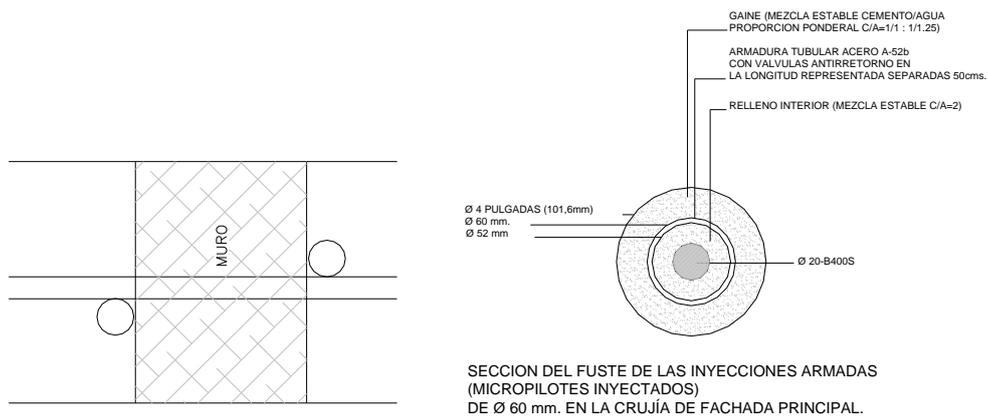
Sección de las inyecciones armadas ejecutadas.
